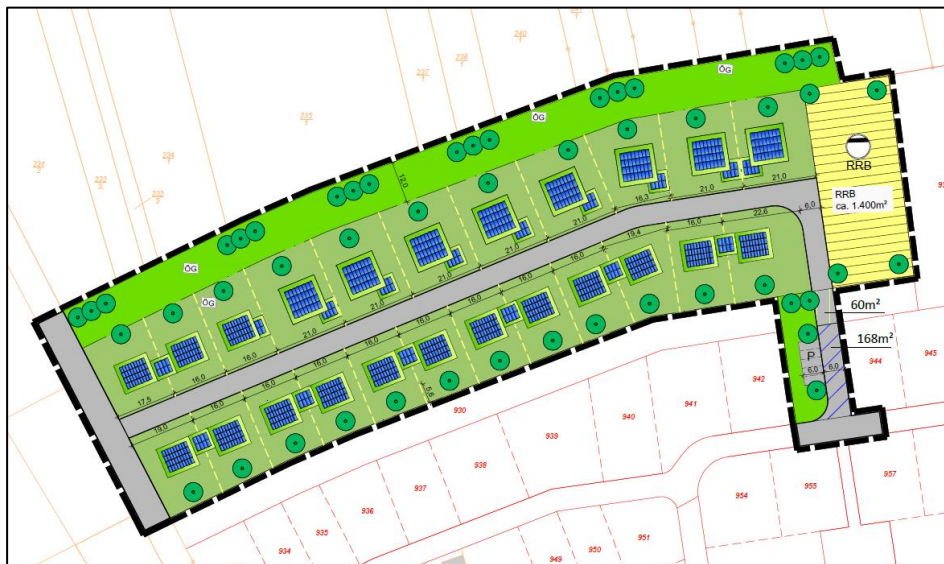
Städtebauliches Konzept als Grundlage für den Bebauungsplan; ohne Maßstab
